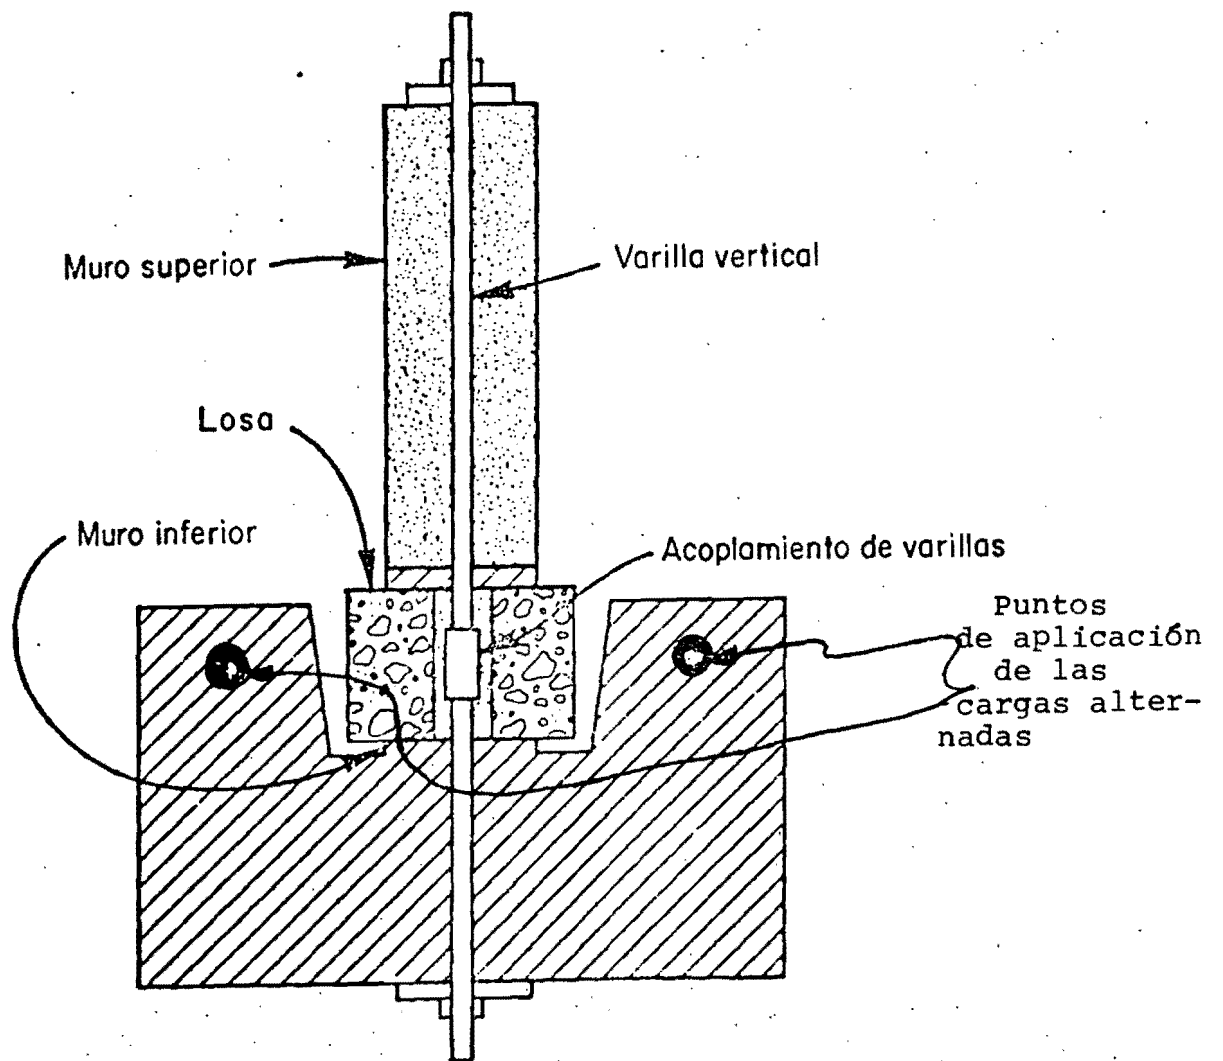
Especímenes con conexiones cortas de la ref 48
